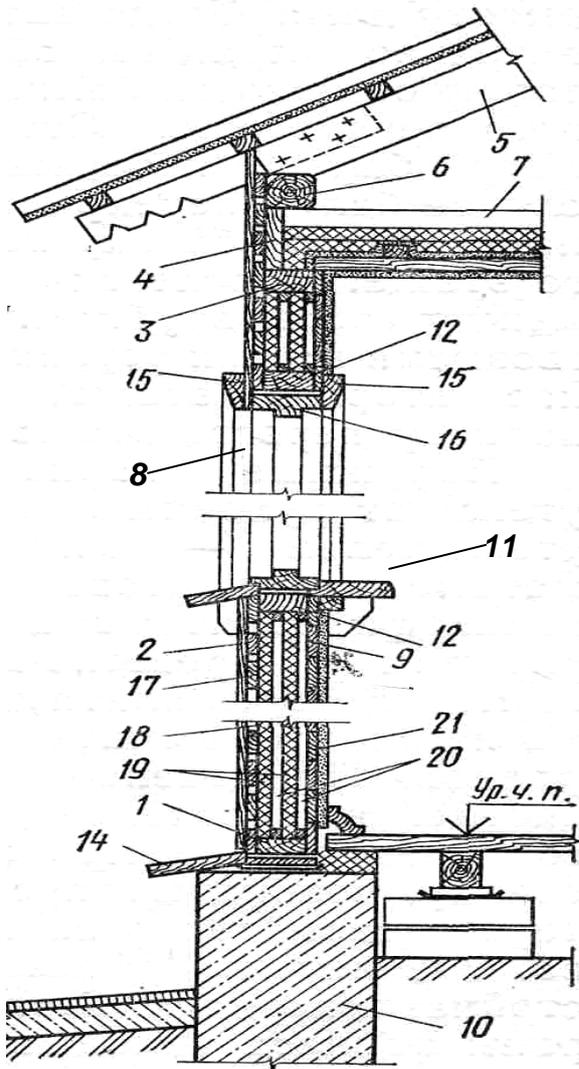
Конструкция деревянного каркасного здания: 1 – нижняя обвязка; 2 – наружная обшивка; 3 – верхняя обвязка; 4 – балка торцовая; 5 – стропильная нога; 6 – мауэрлат; 7 – балка перекрытия; 8 – стойка каркаса; 9 – внутренняя обшивка; 10 – ленточный фундамент; 11 – раскосы жесткости; 12 – горизонтальный оконный ригель; 13 – сливная доска; 14 – наличник; 15 – оконная коробка; 16 – разряженная обшивка из досок; 17 – ветрозащитный слой; 18 – ДВП; 19 – воздушная прослойка; 20 – пароизоляция; 21 – штукатурка
